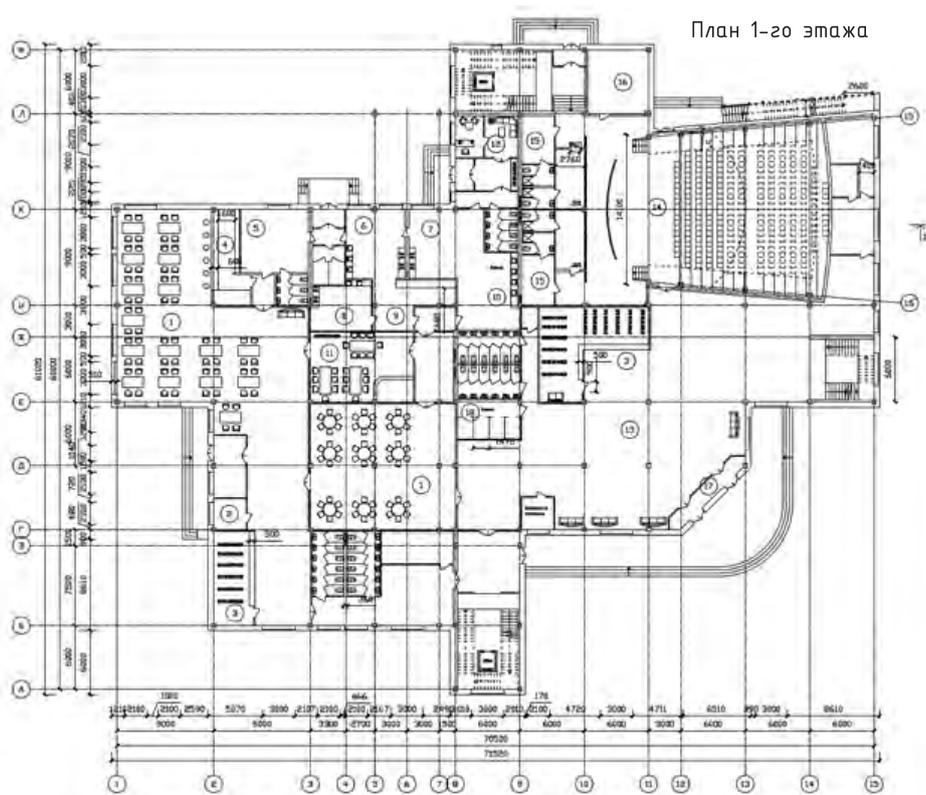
План 1-го этажа каркасного общественного здания (клуб)
